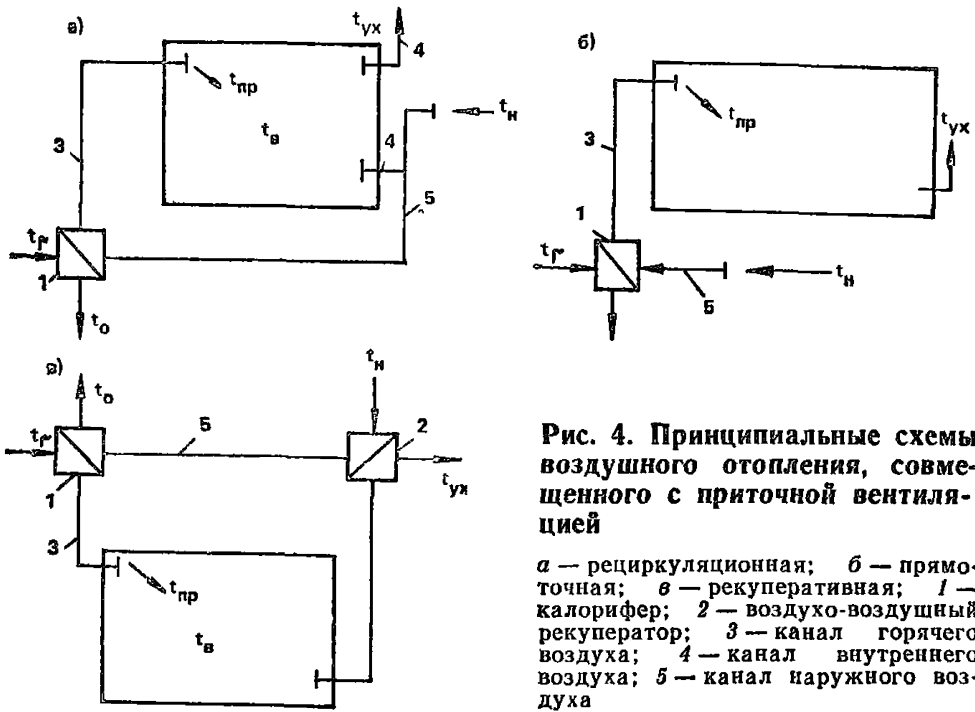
Принципиальные схемы воздушного отопления, совмещенного с приточной вентиляцией
